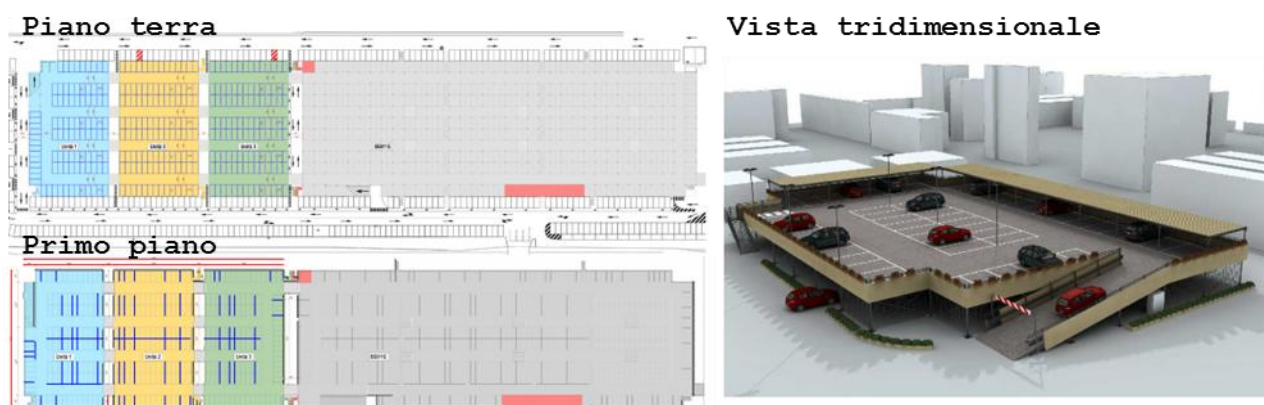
Intervento D1: parcheggio P2 in elevazione, caratteristiche architettoniche
